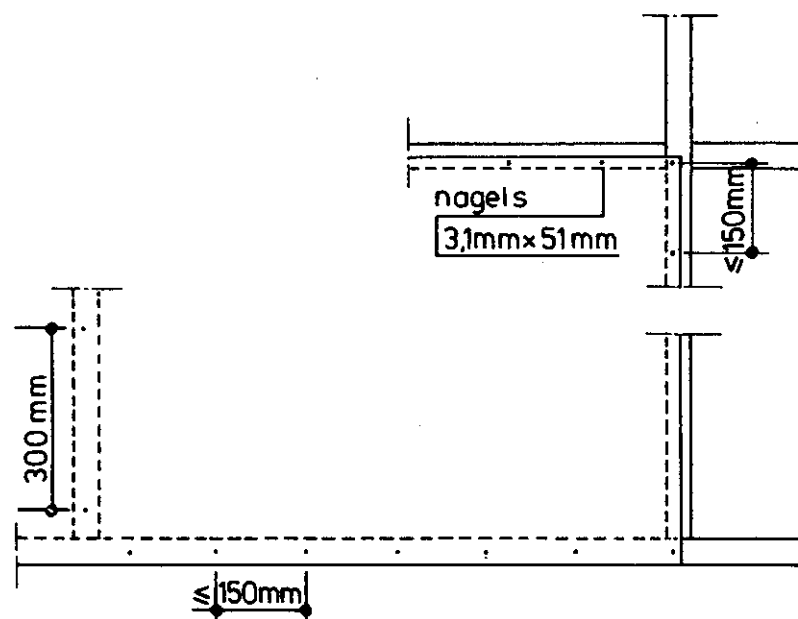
NAGELING VAN DE PLATEN : DETAIL A en B
